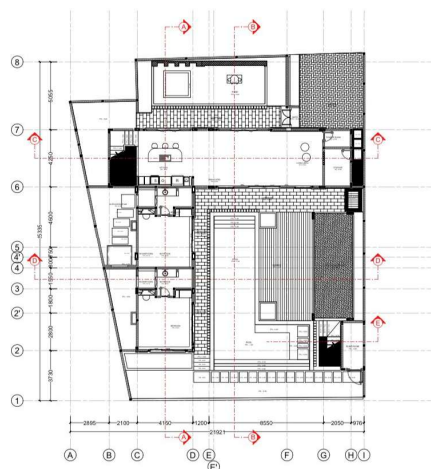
Denah Lantai 1 Proyek Urban Heaven Residence
